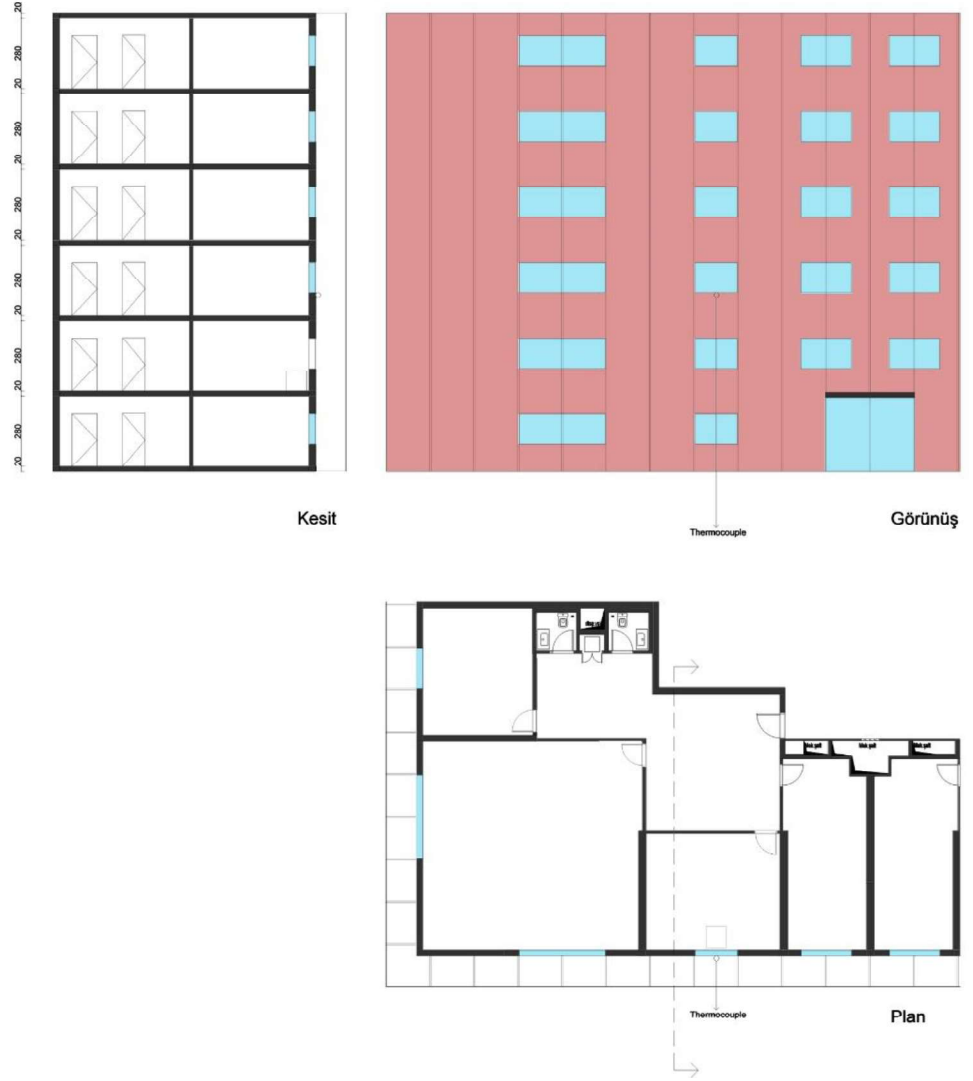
13: A4 modeli plan, kesit ve görünüşü
